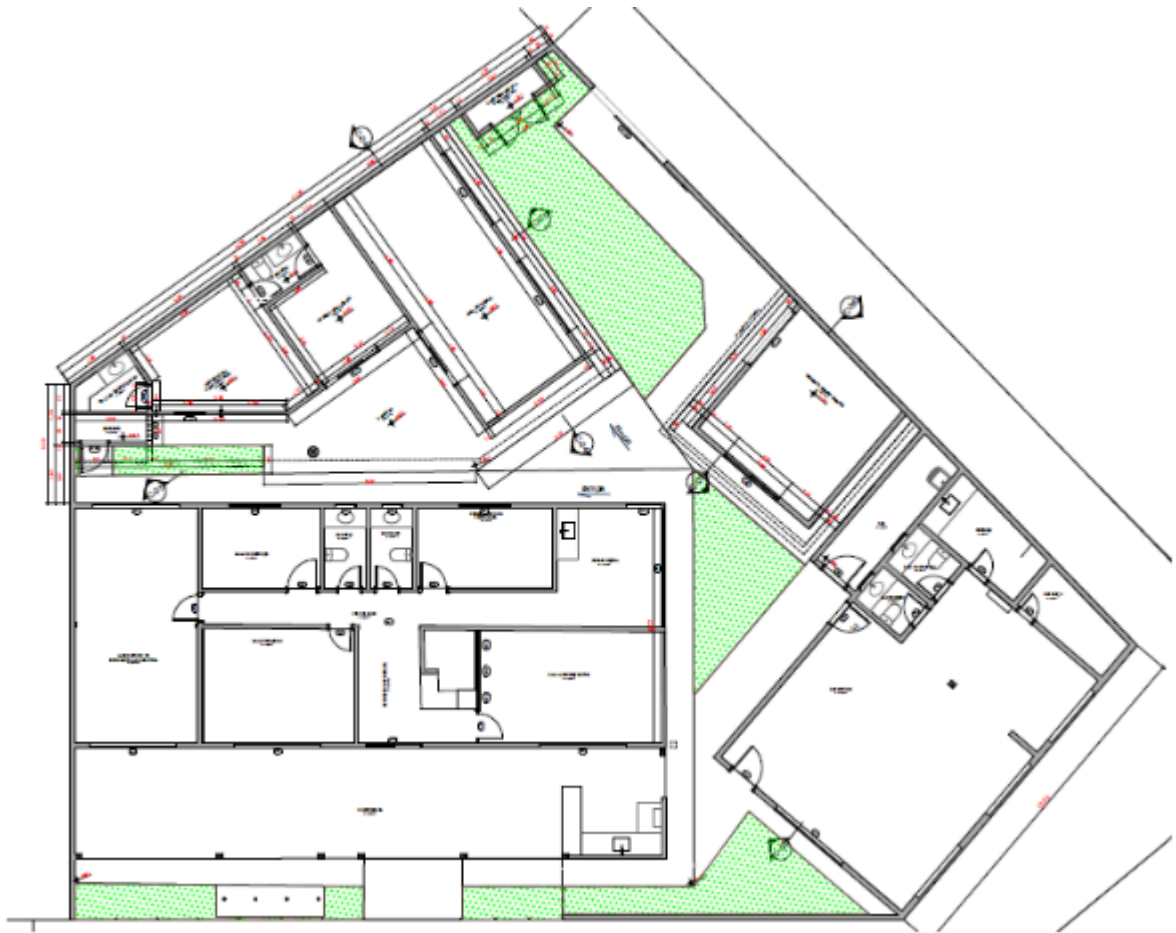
Planta baixa da edificação do anexo médico e cultural
